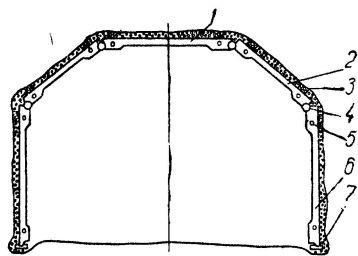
Рама полигональной железобетонной крепи из плит УРП-1: 1 — верхняя; 2 — подкос; 3 — клин; 4 — шарнирный вкладыш; 5 — межрамный болт; 6 — стойка; 7 — фундаментная плита
